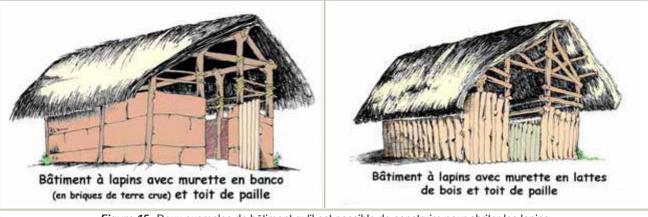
Deux exemples de bâtiment qu'il est possible de construire pour abriter les lapins
